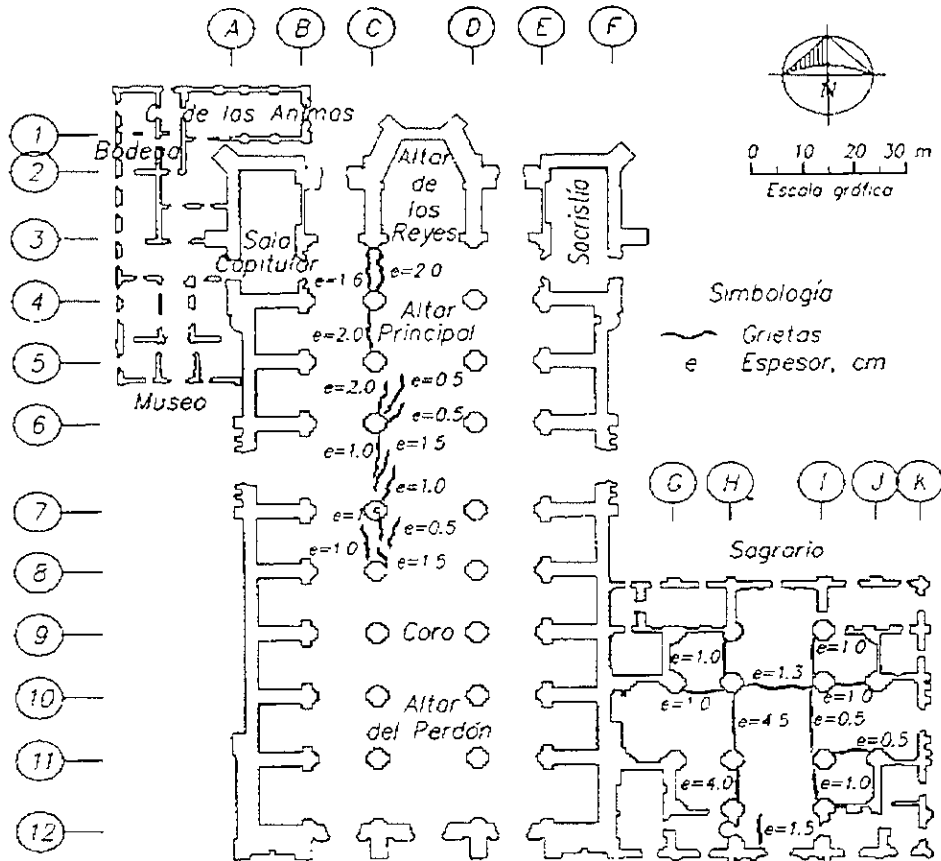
Grietas en el piso. Nov. 1989
